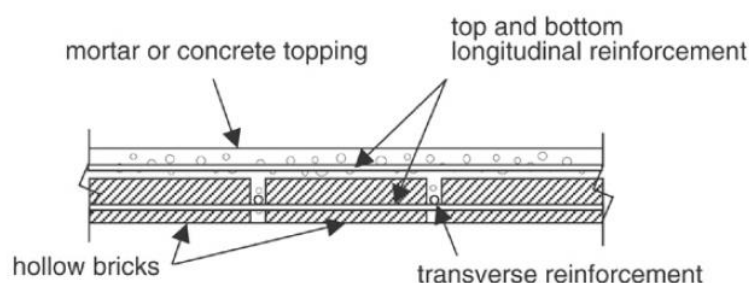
Sección longitudinal de mampostería reforzada (Roca et al., 2007).
